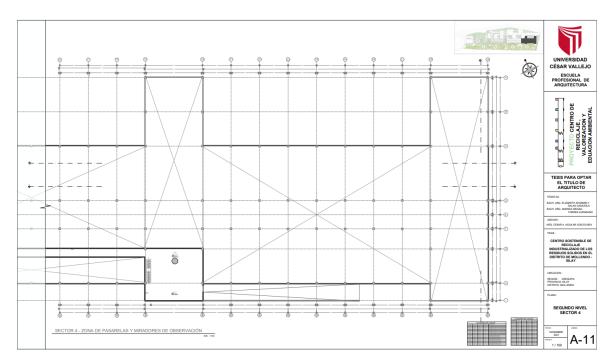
Planta de Distribución, Sector 4 – Segundo Nivel FUENTE: Elaboración Propia
